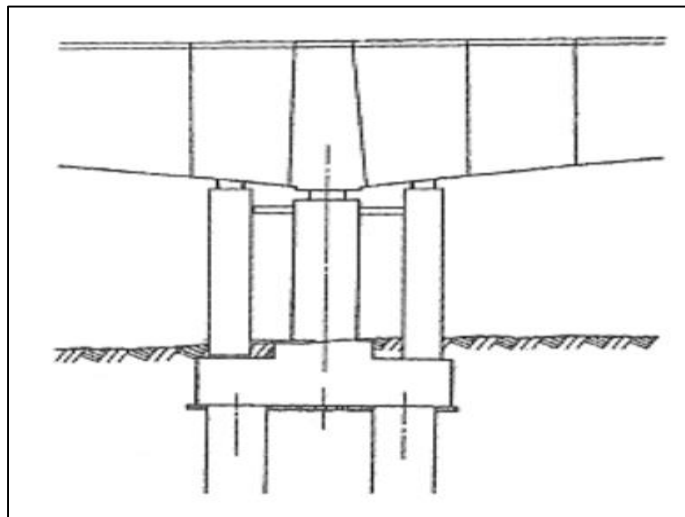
Elévation d'une pile avec palées provisoires.
